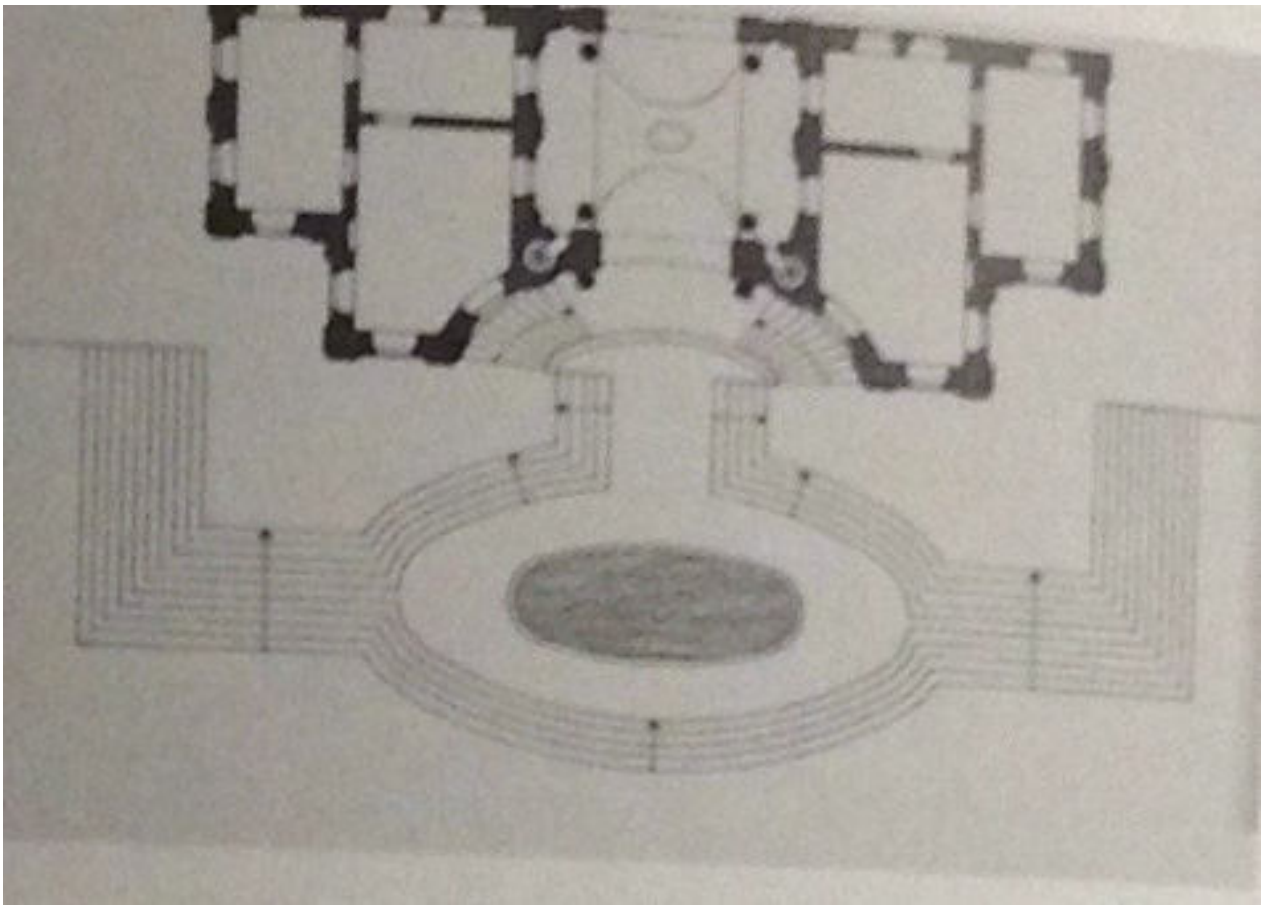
Grundriss des Casinos Liechtenstein
